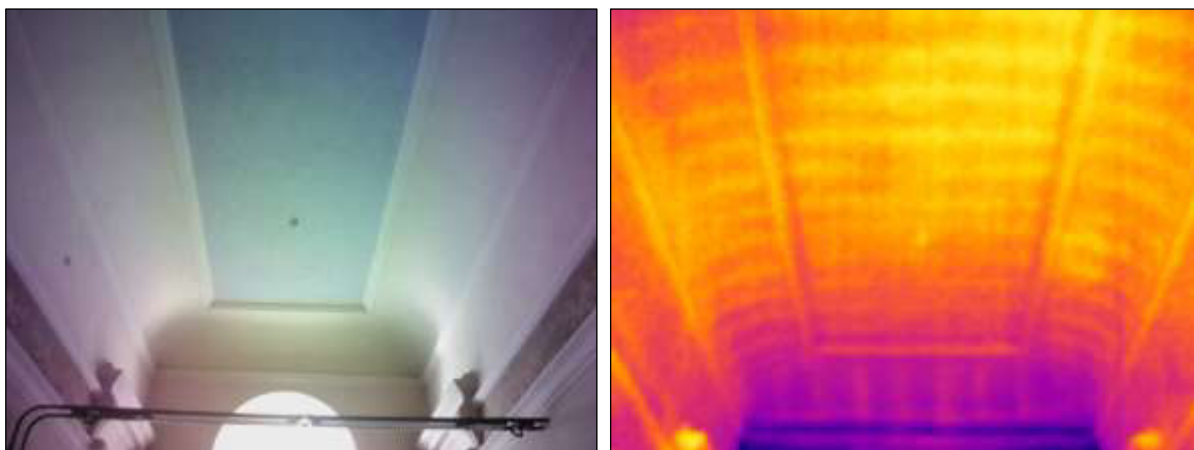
Scansione del plafone dell'Ufficio 6 al piano rialzato riscontrata mediante osservazione all'infrarosso.
